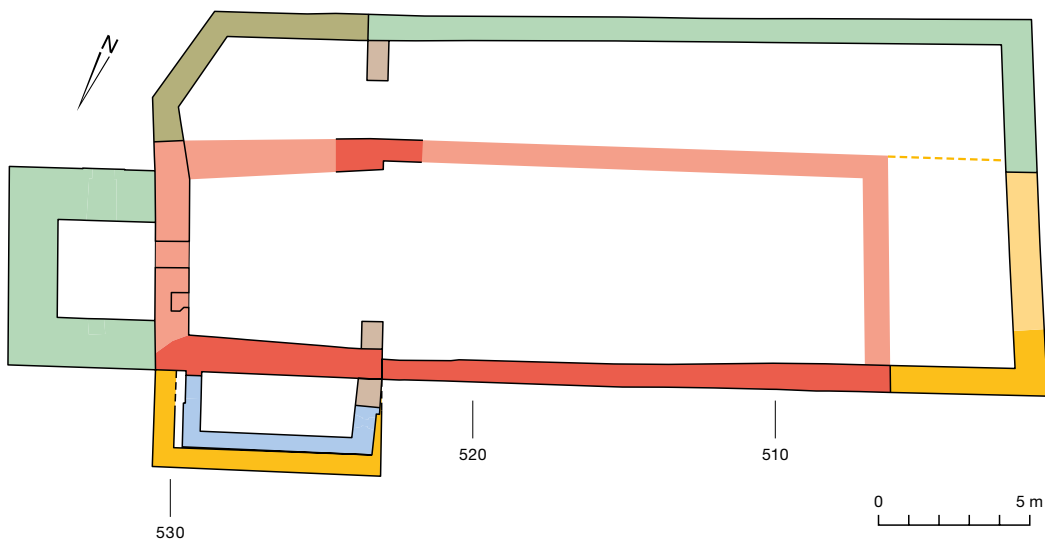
Zweisimmen, Kirche. Grundriss mit den verschiedenen Bauphasen der Kirche. Rot: älteste fassbare Kirche; orange: Erweiterung nach Westen sowie Anbau an der Nordseite; grün: mutmassliche Verbreiterung nach Süden und Glockenturm; braun und olive: Umbauten des 15. Jahrhunderts. M. 1:250.
